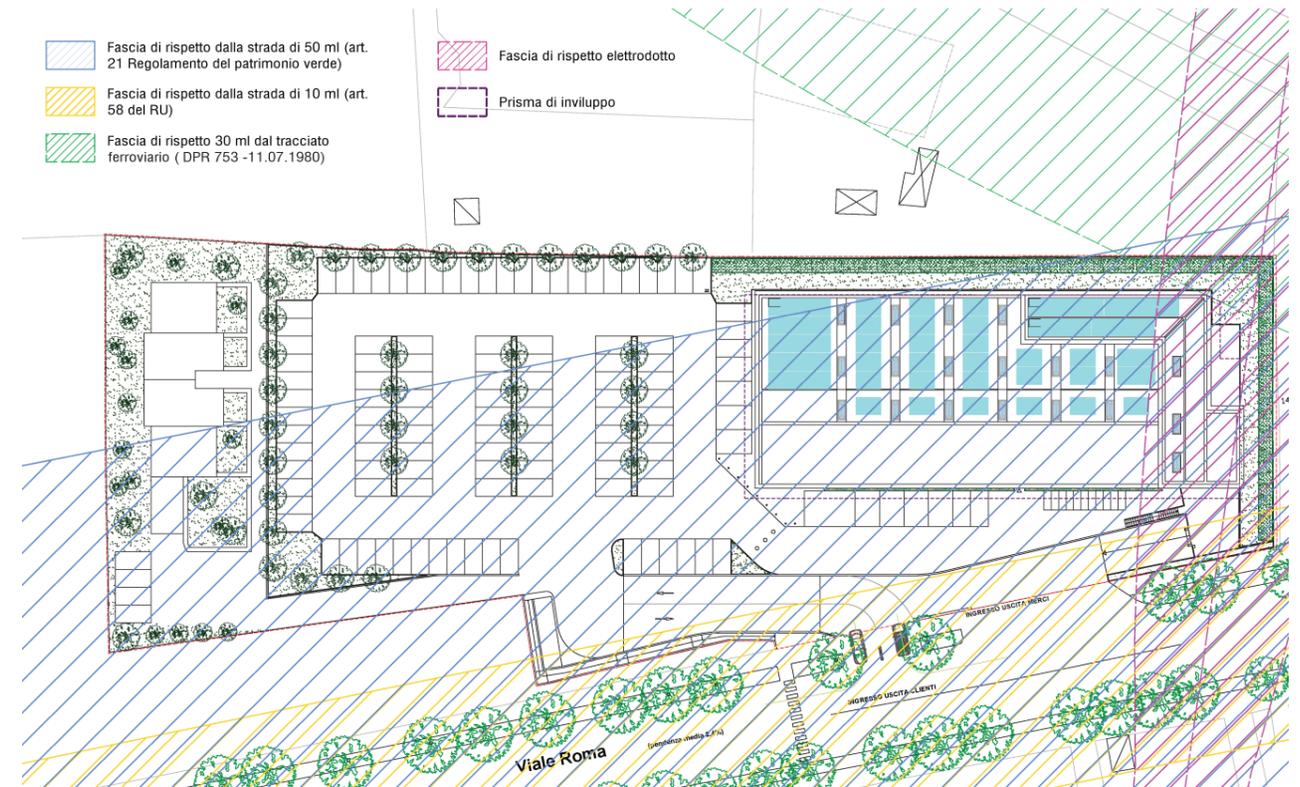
Planimetria del Piano attuativo con indicate le fasce di rispetto DPR 753-11 Luglio 1980
